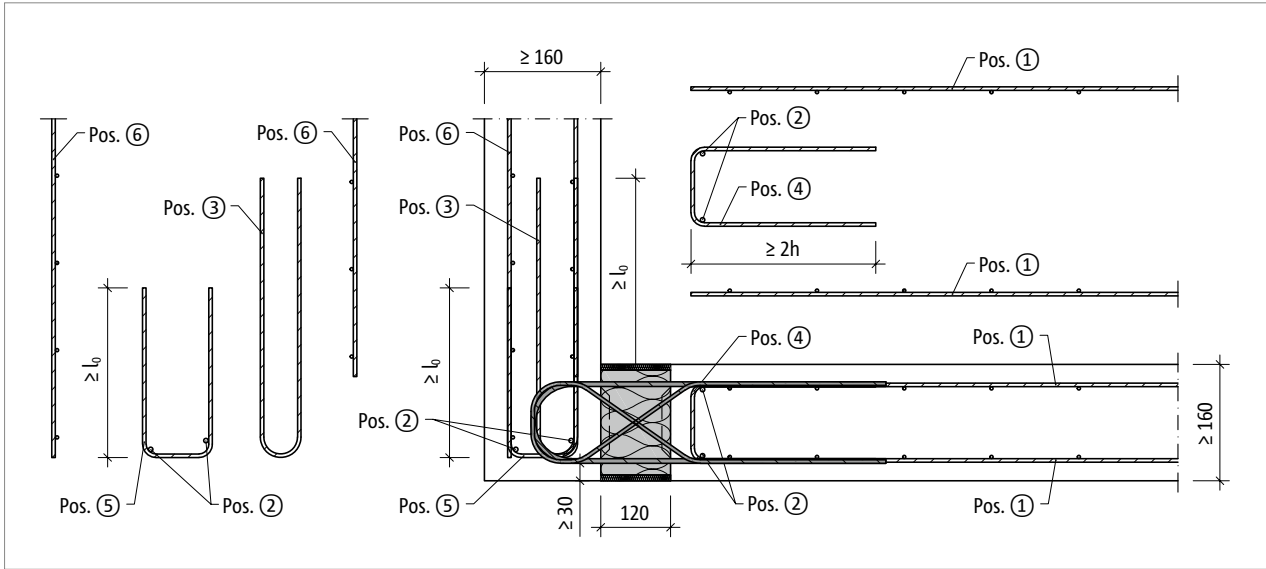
Schöck Isokorb® XT/T Typ AP horizontale Anordnung: Bauseitige Bewehrung
